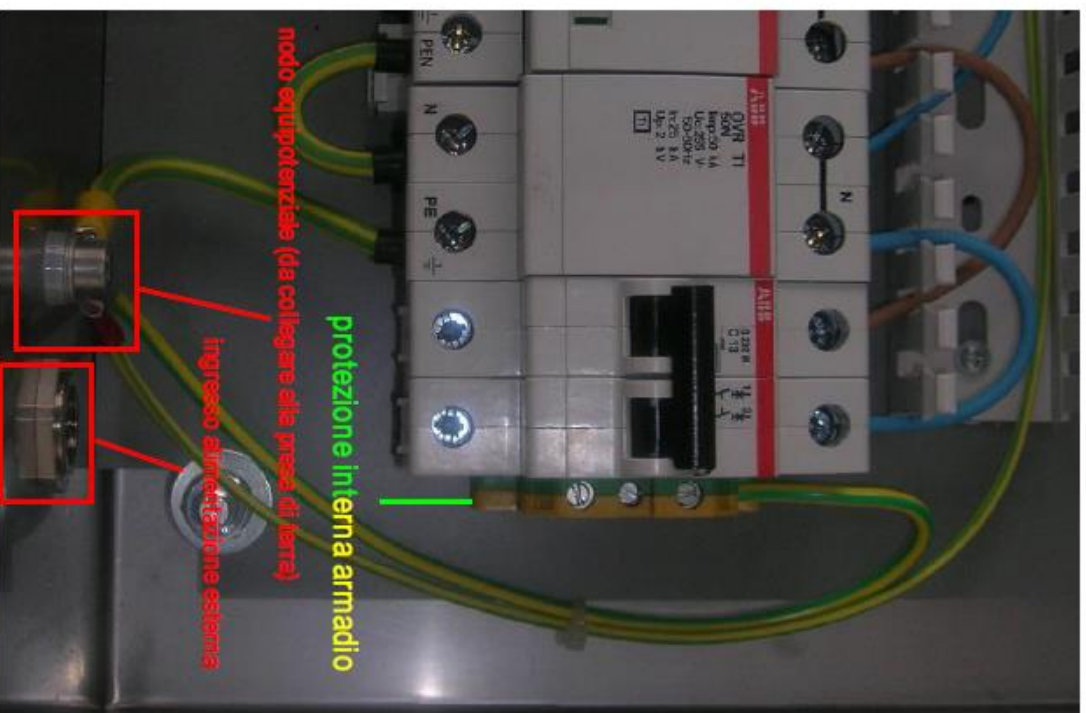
Particolare presa di terra e ingresso alimentazione esterna -
